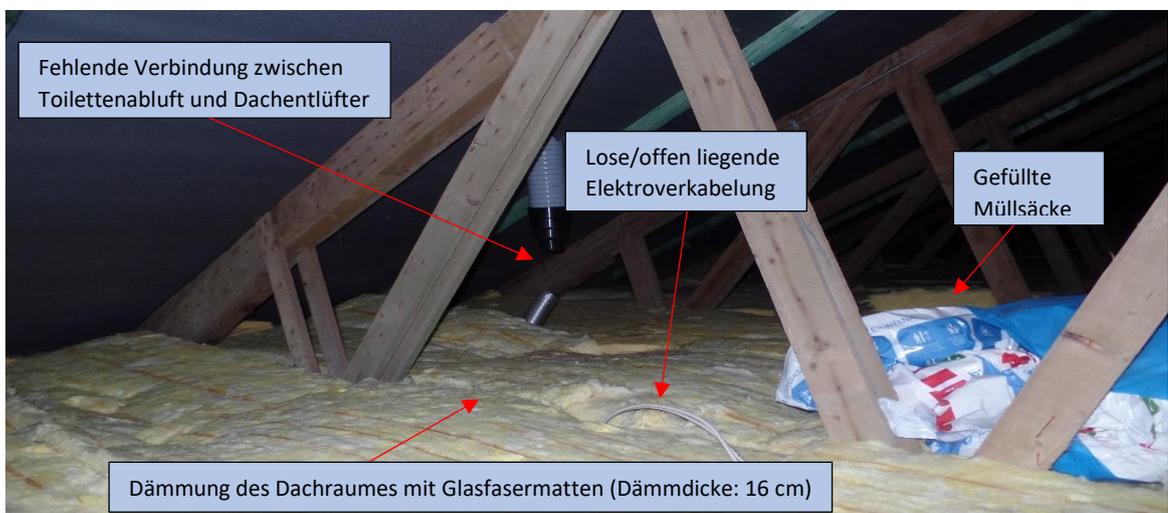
Blick in den Dachraum (nicht begehbare Dämmung mit Glasfaserplatten, Mülltüten, Abluftrohr der Damentoilette ohne Verbindung zum Dachentlüfter, offen liegende Elektroverkabelung)
